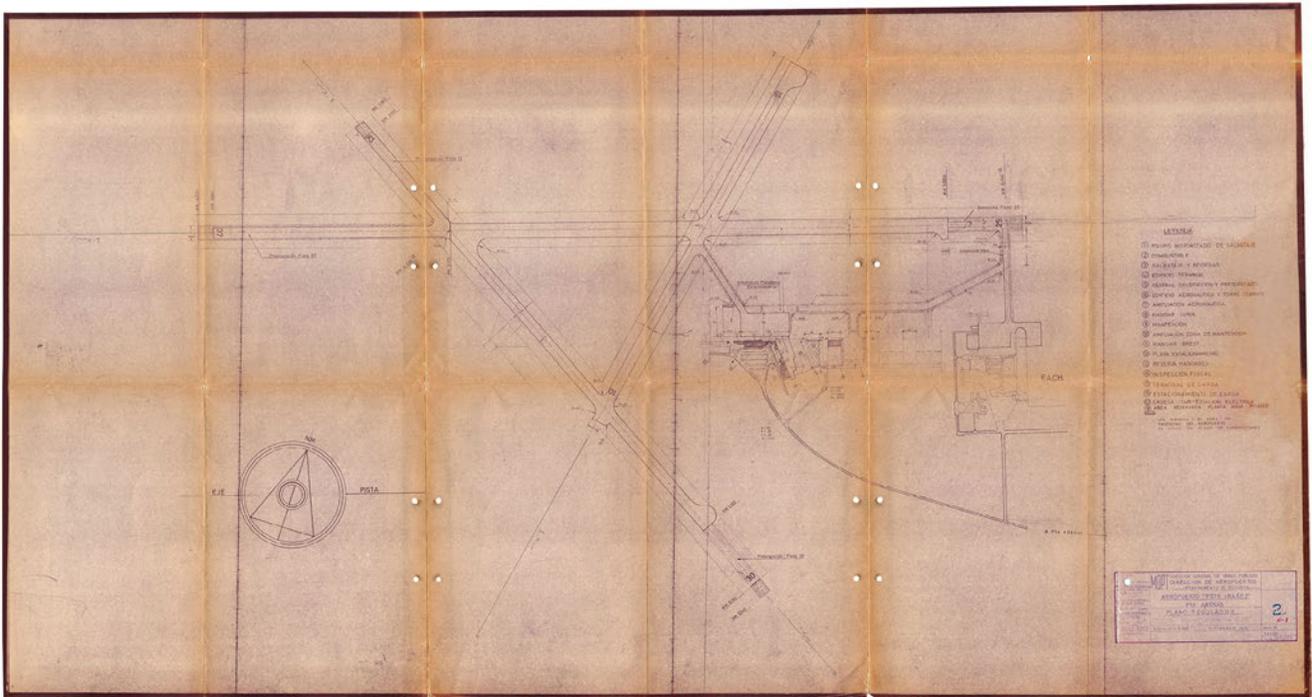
Plano regulador (fuente: Ministerio de Obras Públicas, 1971).
